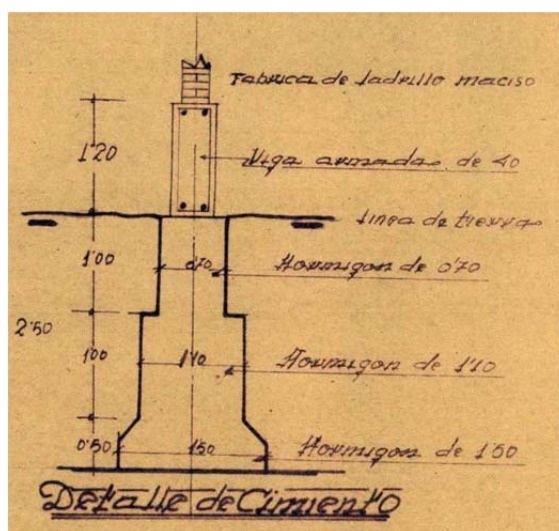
Detalle original de cimentación (Archivo Fidas-Coas).
